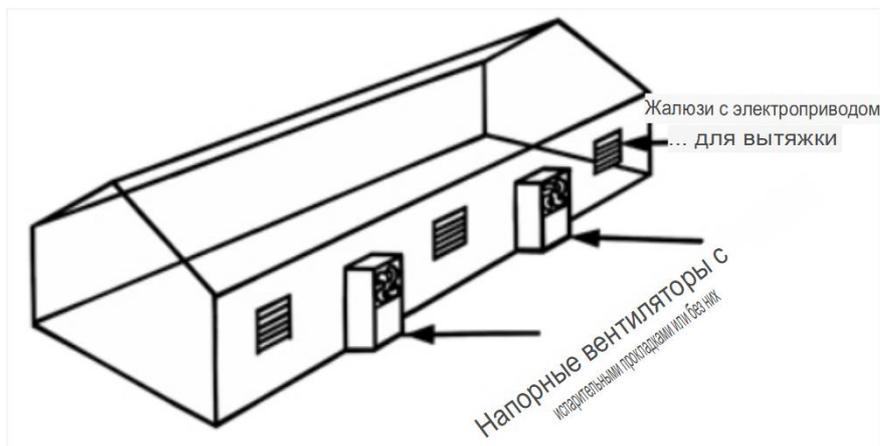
Нагнетательные вентиляторы, установленные в боковых стенах.
